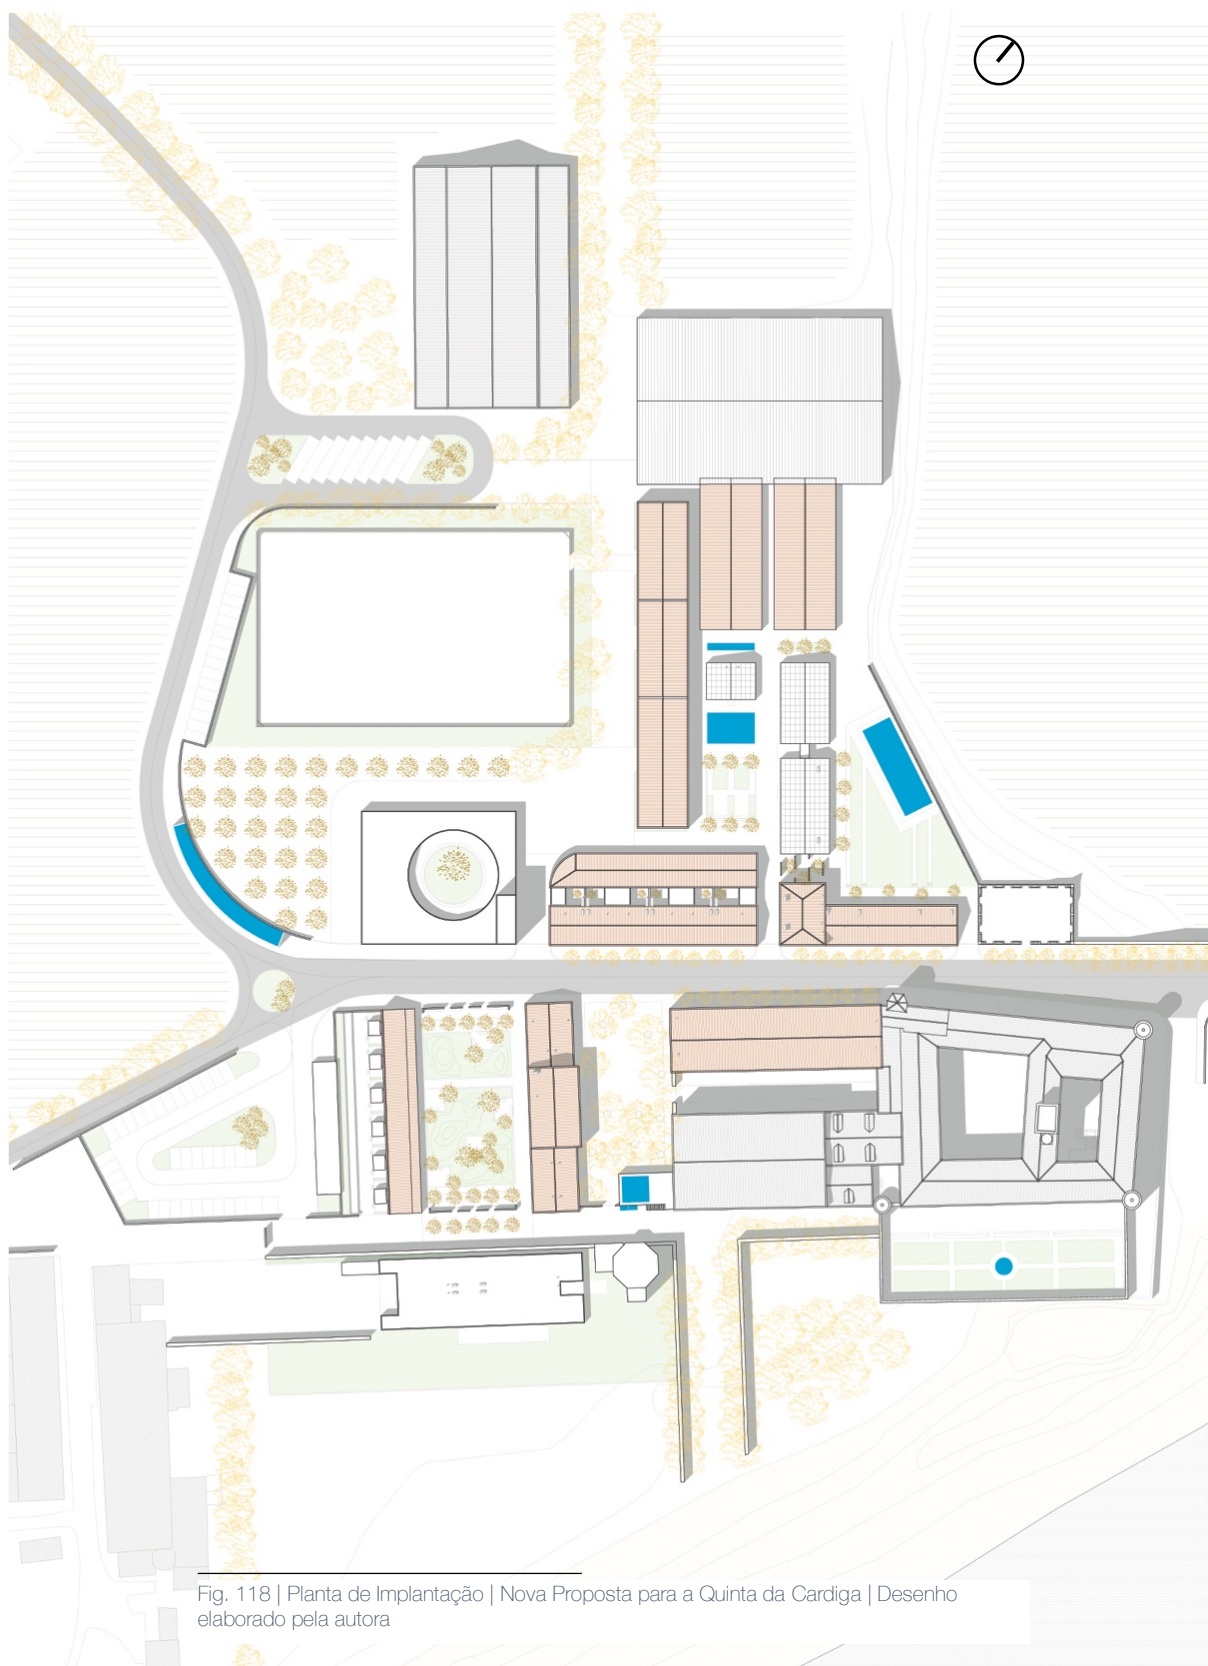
| Planta de Implantação | Nova Proposta para a Quinta da Cardiga | Desenho elaborado pela autora
